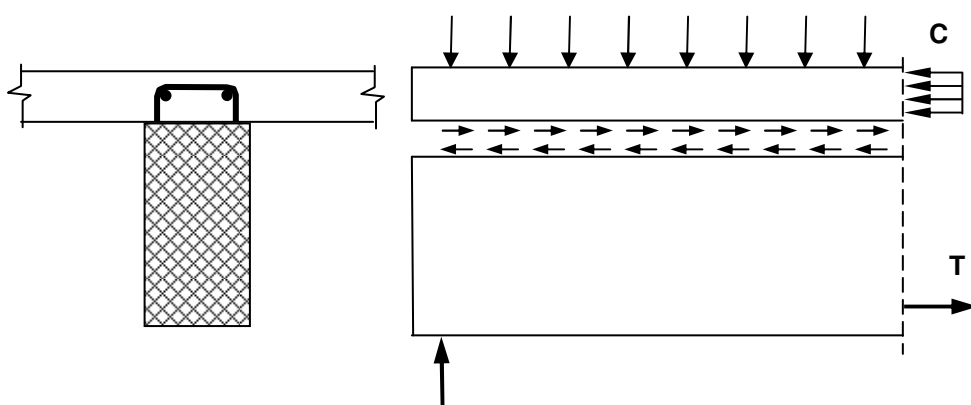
Rost între grinda prefabricată și placa turnată monolit
